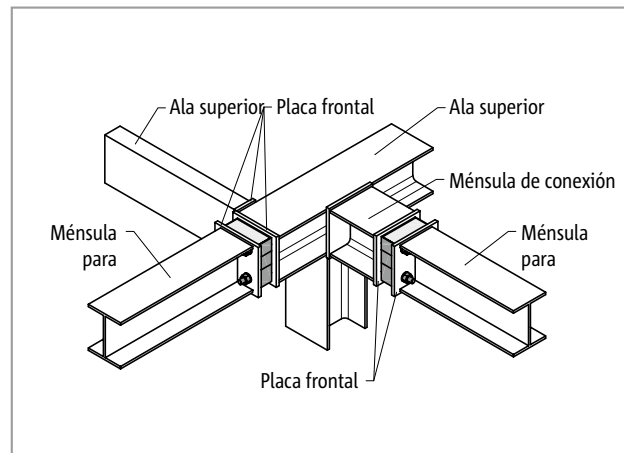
Schöck Isokorb® T tipo S: Esquinero externo
